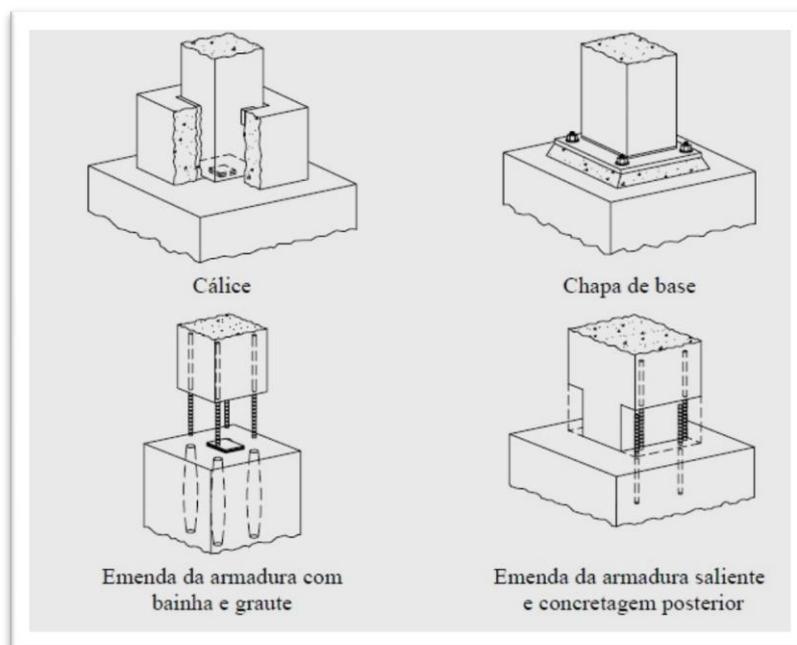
Tipos de Ligações entre o pilar e a fundação
